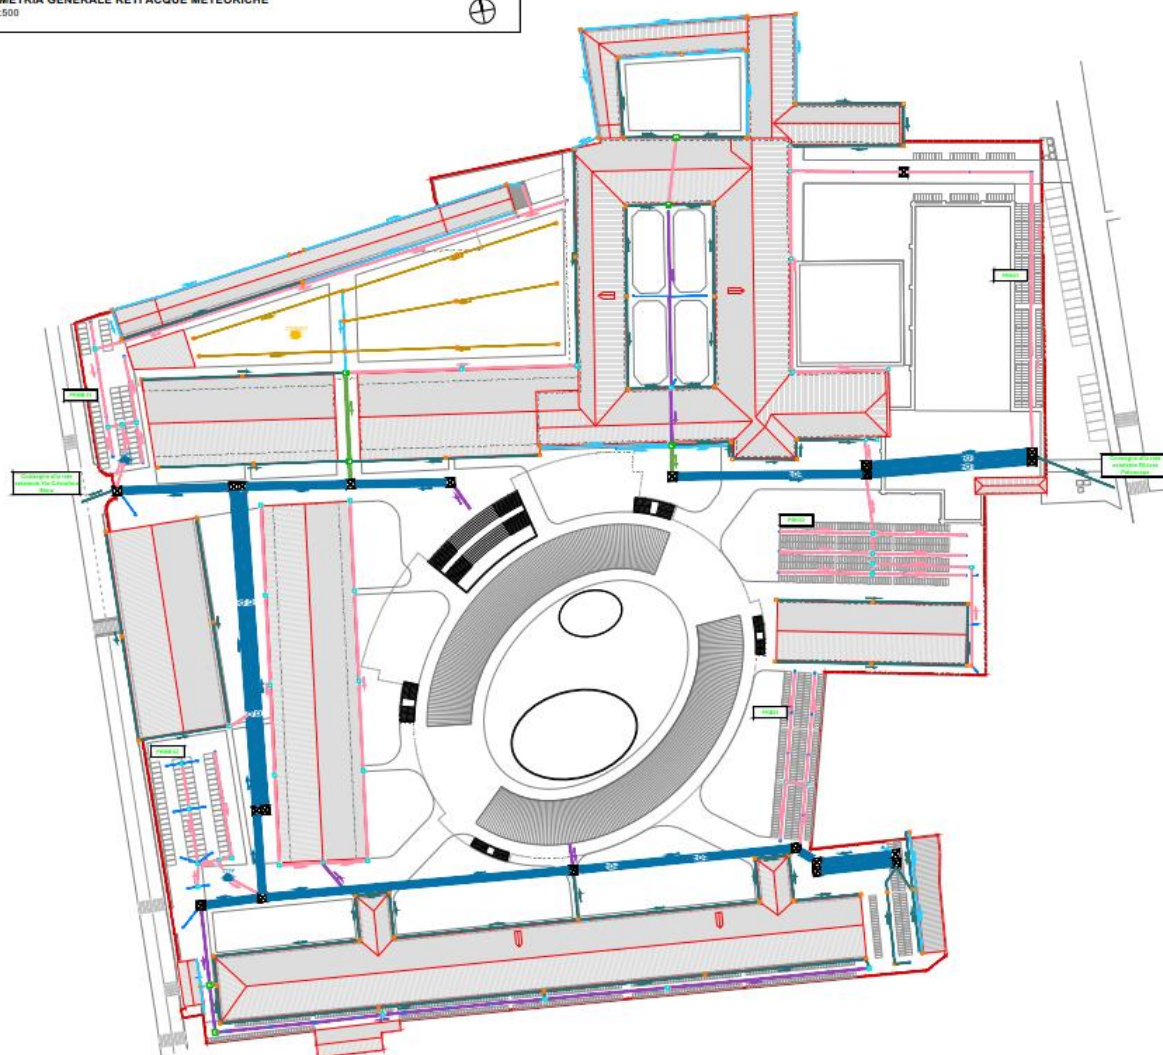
Planimetria di Progetto Rete delle Acque Meteoriche
